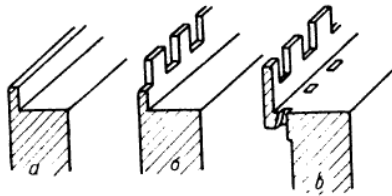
Брустверная стенка: а — парапет; б — зубцы с бойницами; в — зубцы с навесными бойницами [4]
